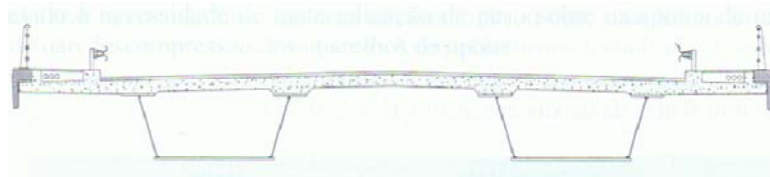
Secção transversal tipo da solução em vigas caixão [R7]
